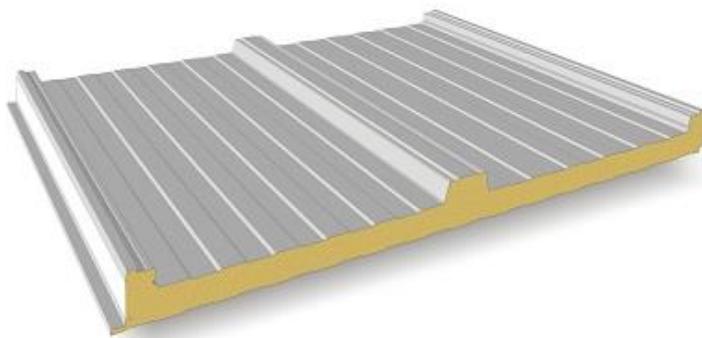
Panel sándwich cubierta. Fuente: CYPE Generador de precios
